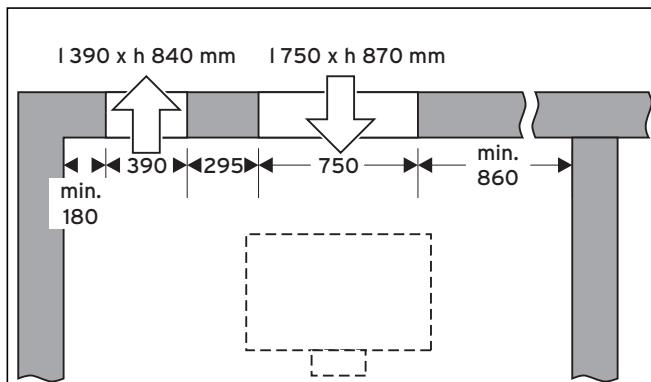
Installation sur un mur, sortie d'air à gauche
